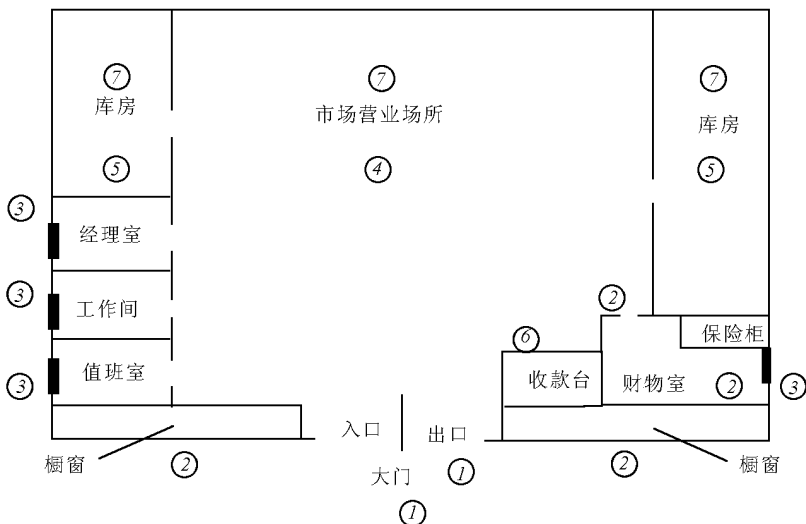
小型自选商场的平面图和所采取的技防措施示意图
